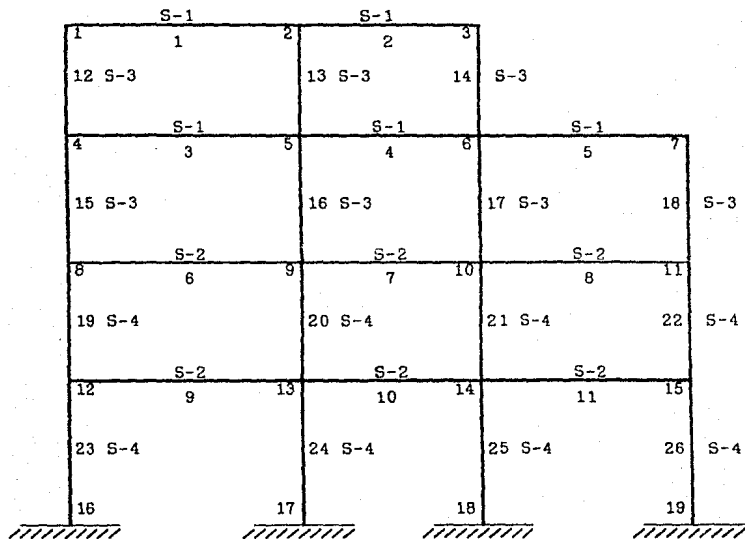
Las secciones de cada barra deberán quedar en una figura de este tipo para mejor identificación, esto es para todos los marcos o elementos estructurales.
